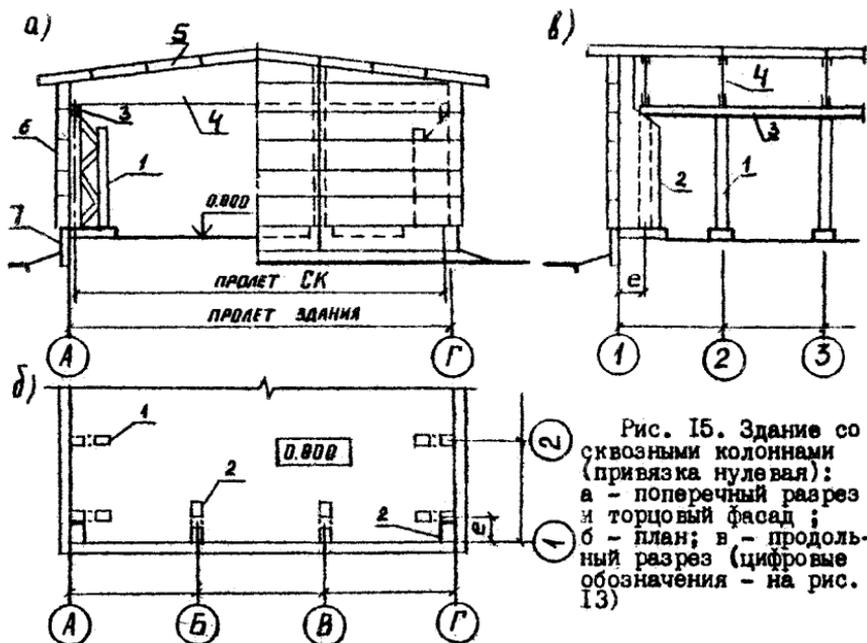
Здание со сквозными колоннами (привязка нулевая): а - поперечный разрез и торцовый фасад; б - план; в - продольный разрез (цифровые обозначения - на рис. 13)
